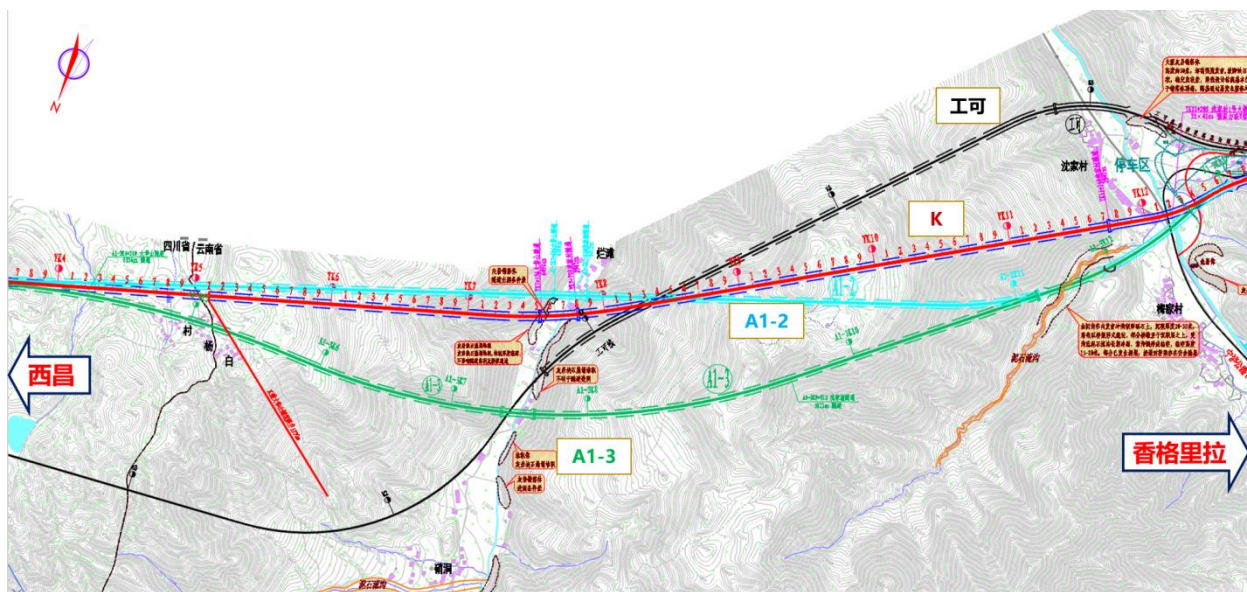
K、A1-2、A1-3 方案比较平面图
